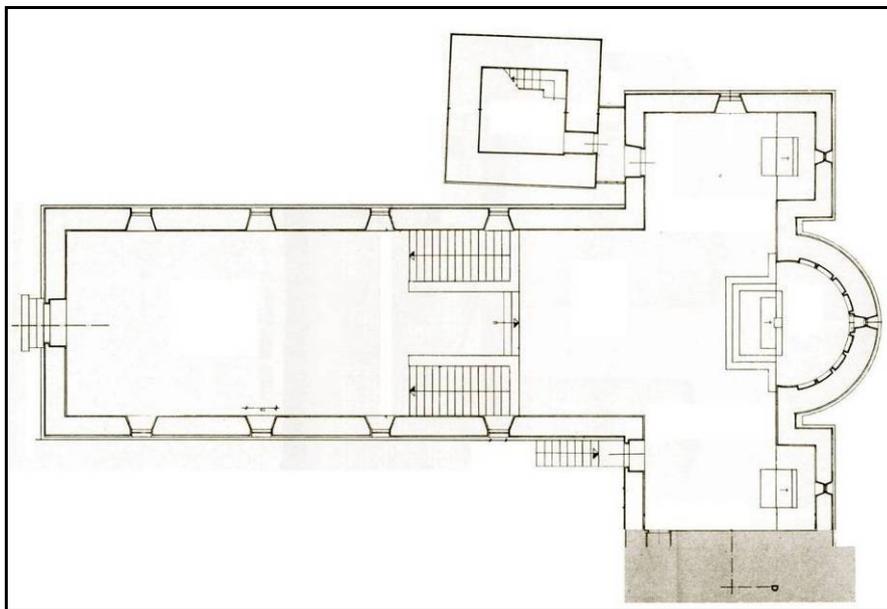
San Baronto: pianta [da VIOLANTI 1983]
